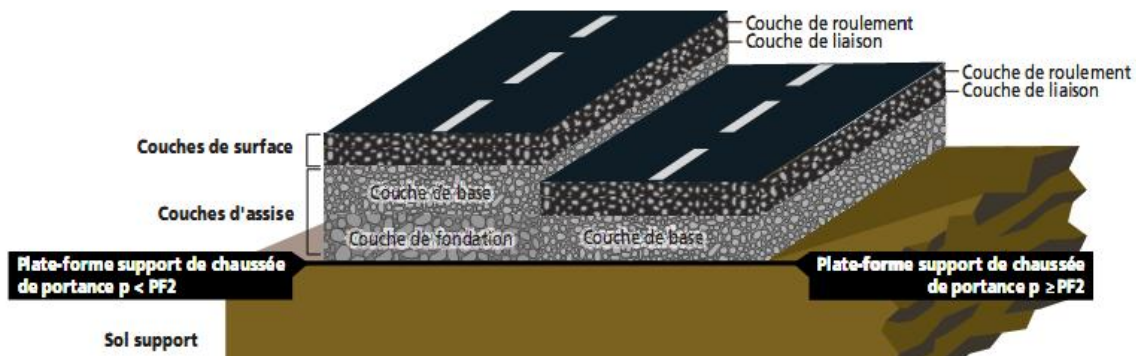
Structure type d'une chaussée semi-rigide [9]
